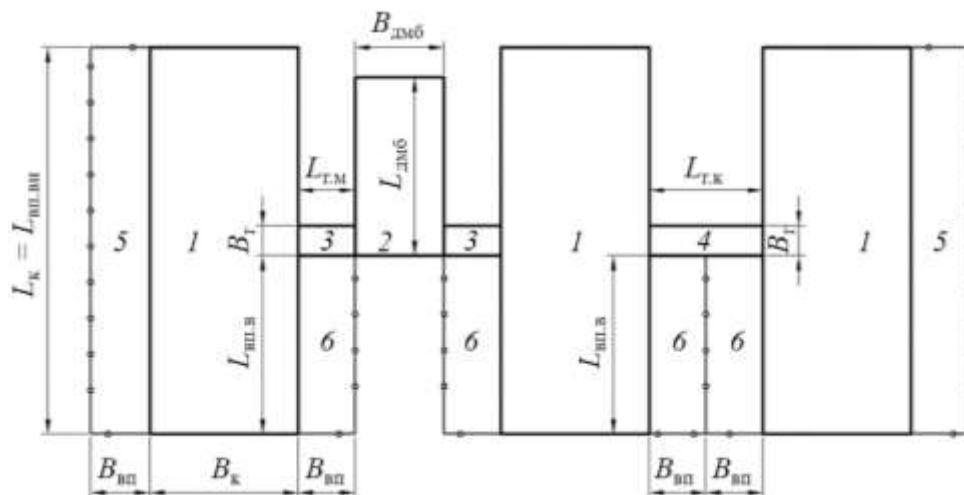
Схема к определению размеров выгульных площадок и соединительных галерей:
